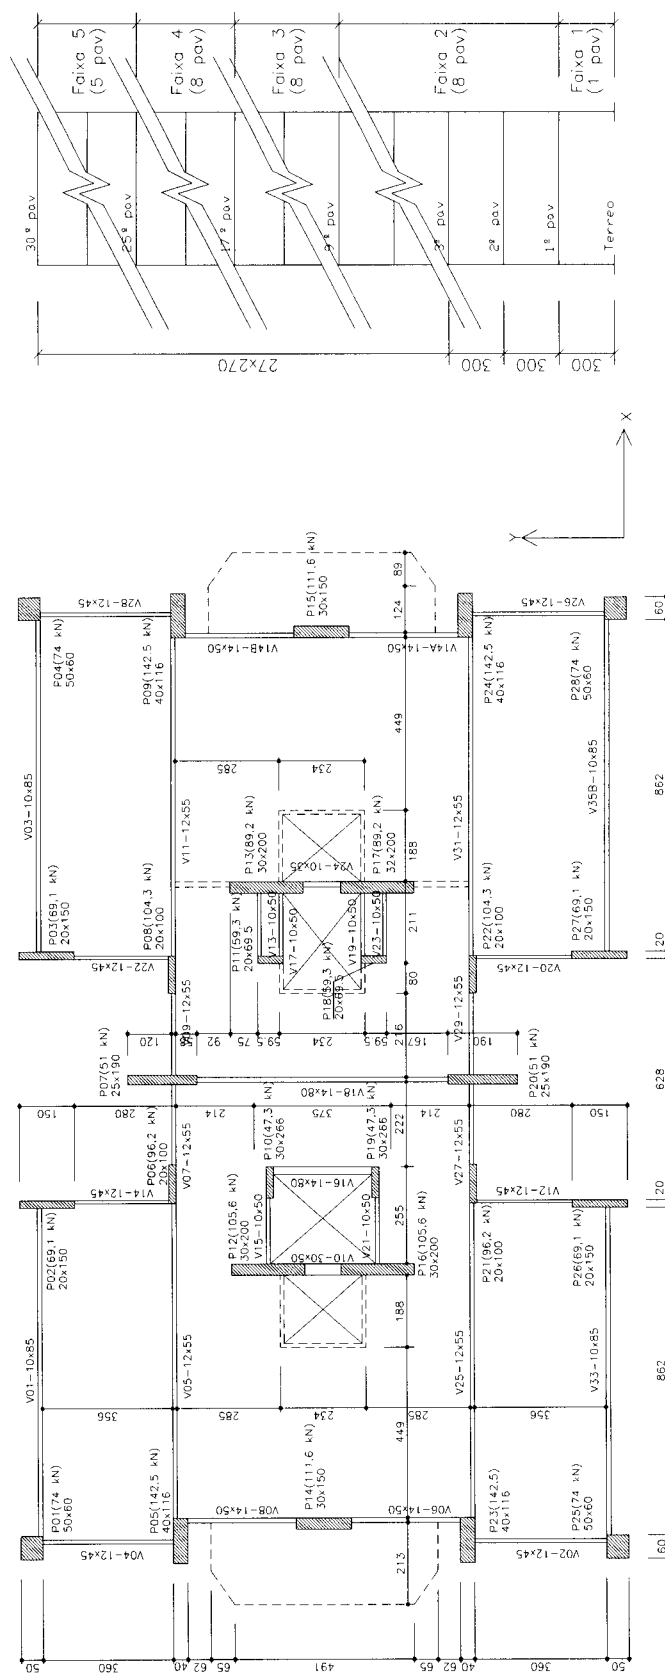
Edifício TORRE PERDIZES (geometria e carga nos pilares)
